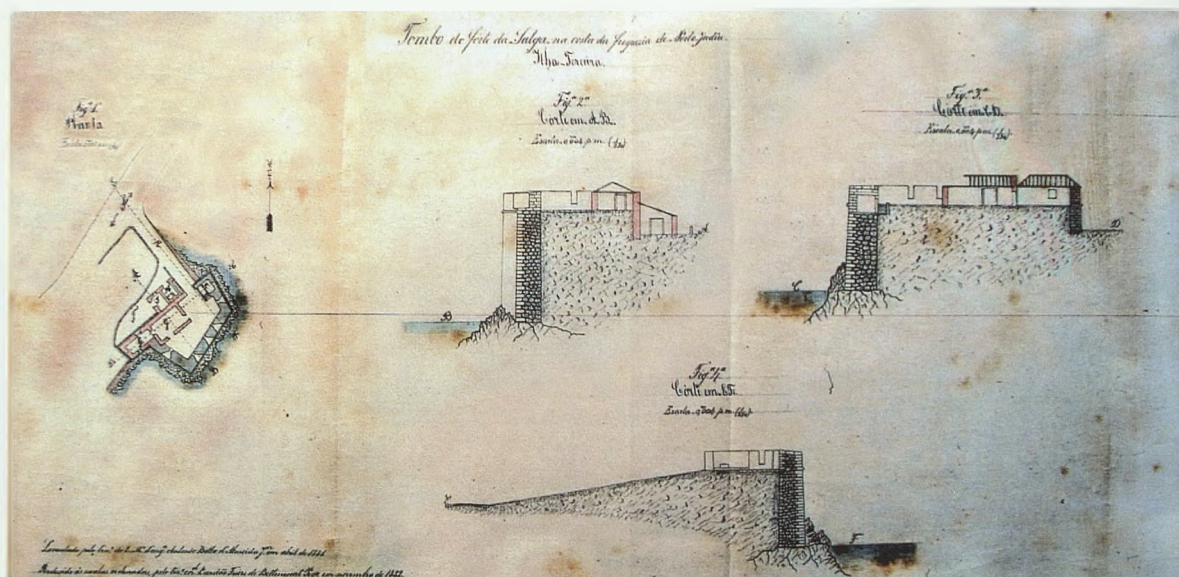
Planta y secciones del fuerte desaparecido de Salga, según Bettencourt (1881)
